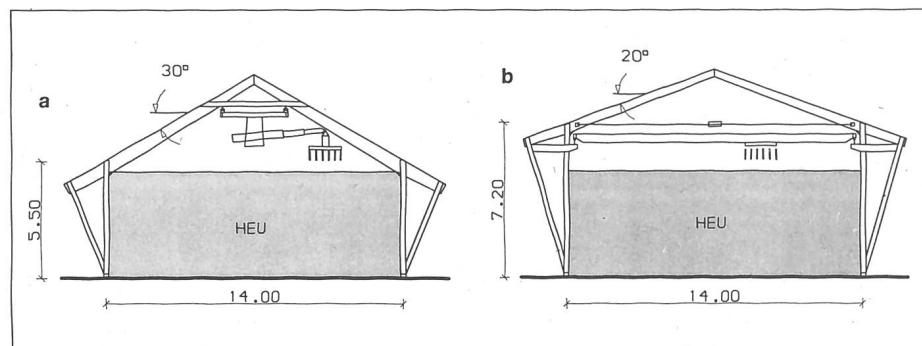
Heulagerhalle in Holzbau (Leimbinder mit V-Stützen). a. Halle mit Auslegerdrehkran; b. Halle mit Hallengreifer.
